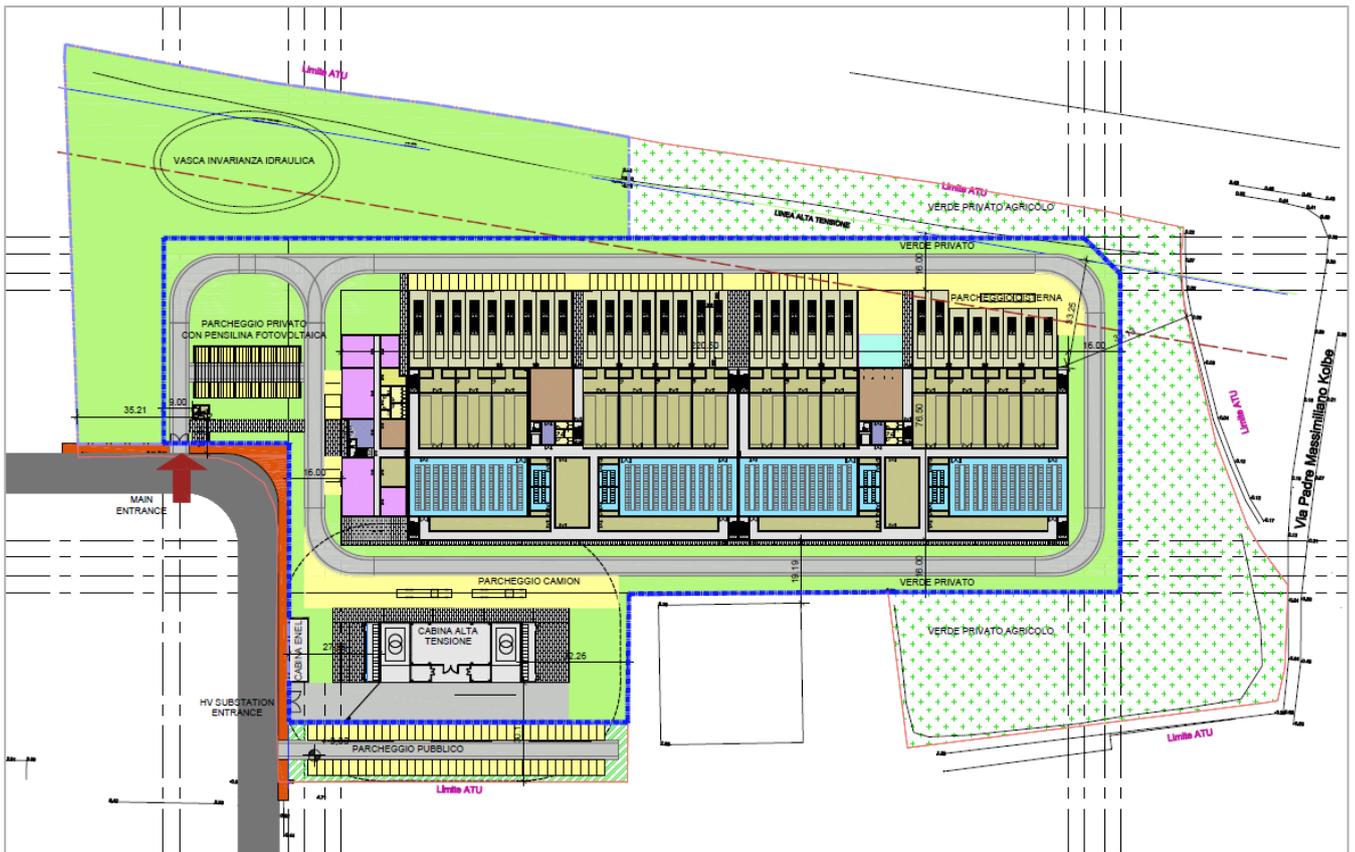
Planivolumetrico delle opere, tratto dal progetto
